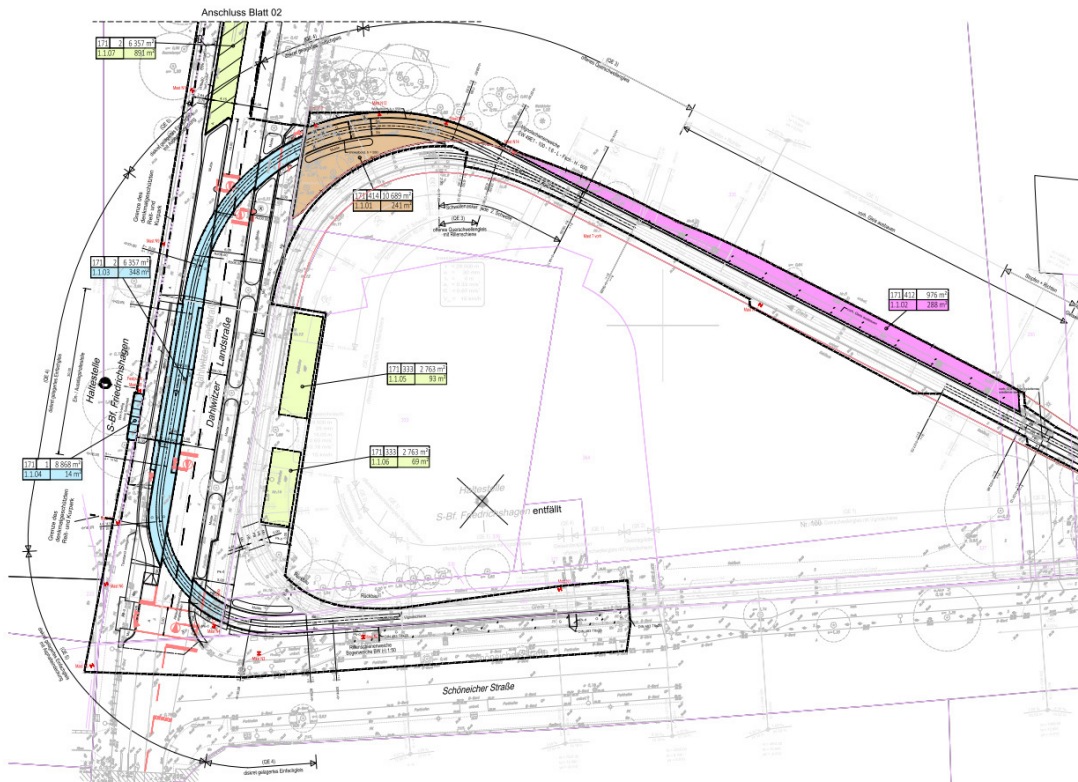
Ausschnitt Grunderwerbsplan (Anlage 6a)
